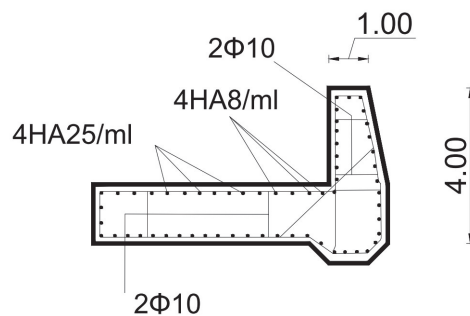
Schéma de ferrailage du mur de couronnement de la jetée secondaire
